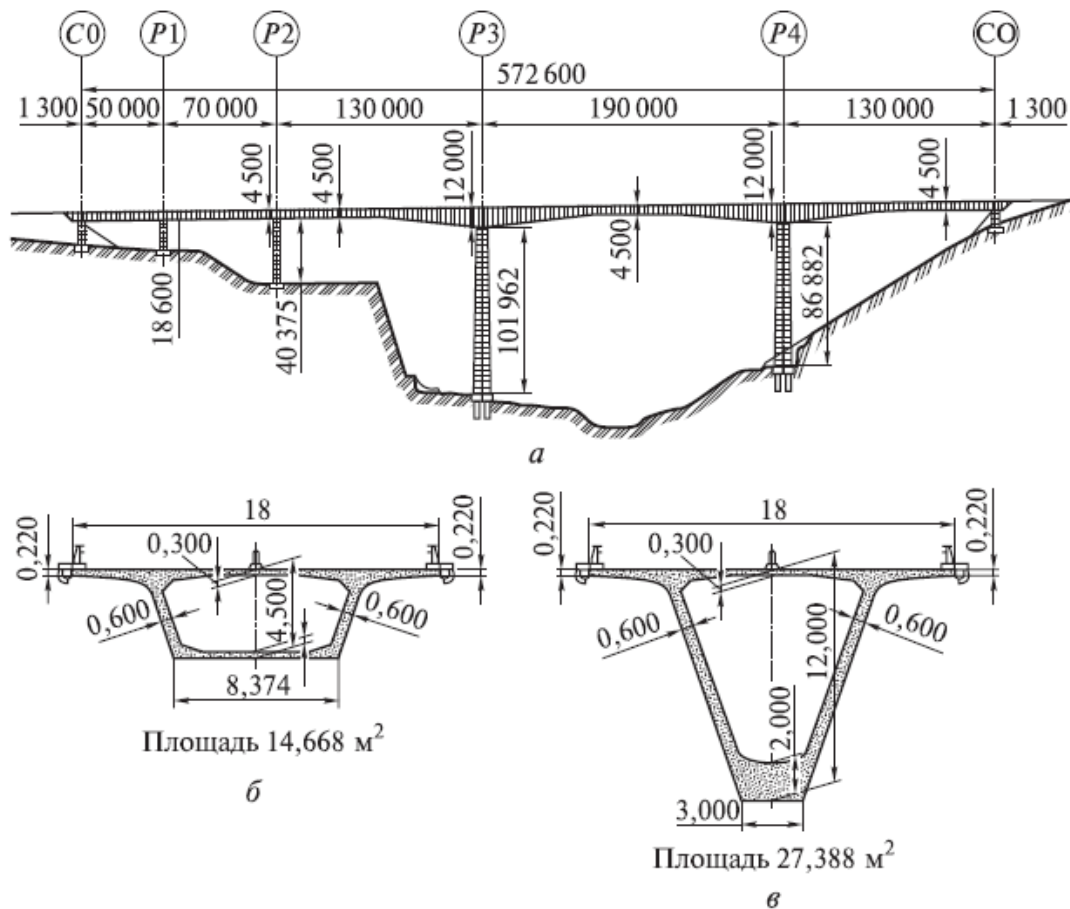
Фасад (а) и поперечные сечения (б, в) современного рамного моста
